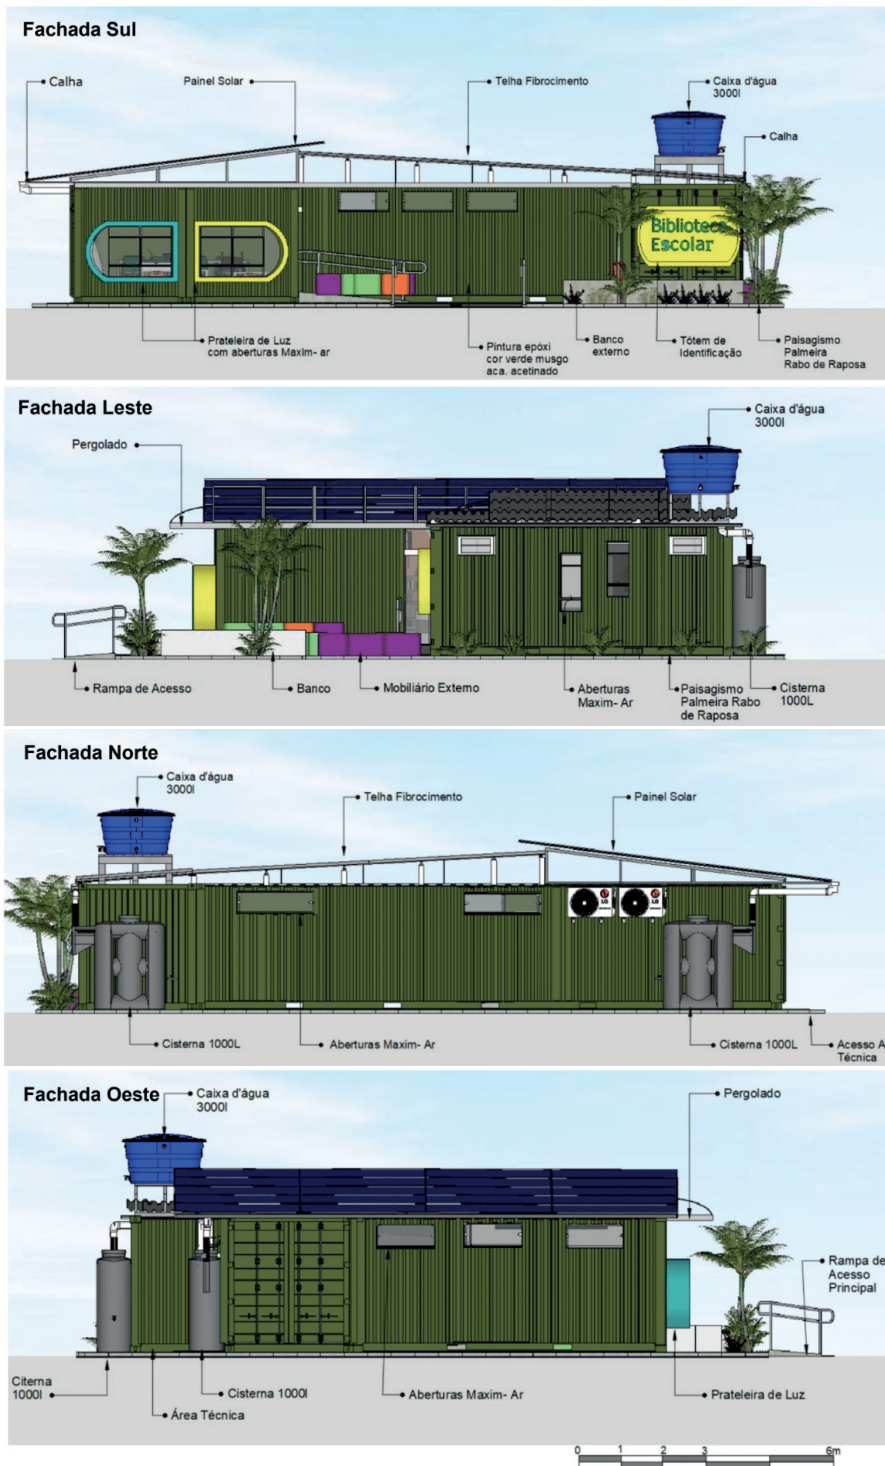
Demonstrativo das Fachadas Sul, Leste, Norte e Oeste
